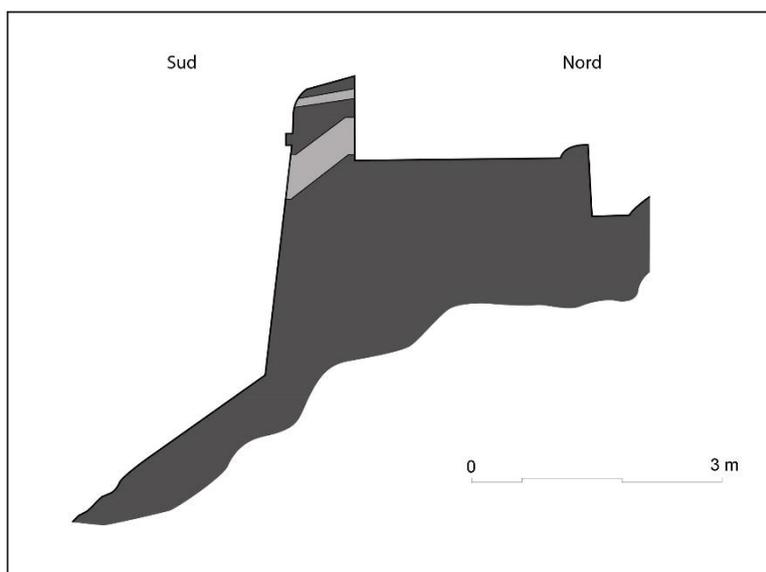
coupe du parapet de l'enceinte fortifiée jouxtant la porte 8 (indiqué par un trait rouge sur le plan général du fort)
